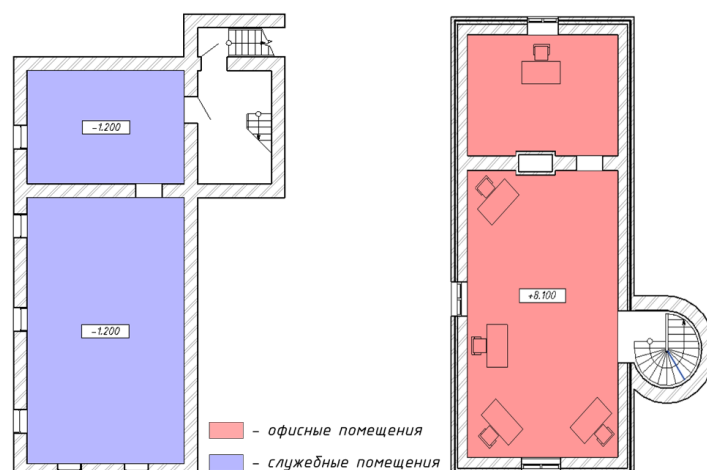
План зонирования цокольного этажа (слева) и мансардного этажа (справа) запасного дома
